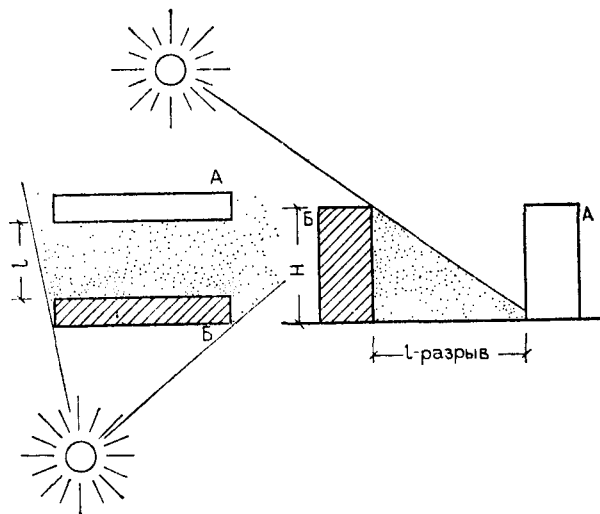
Схема санитарных разрывов между жилыми зданиями. План, разрез
